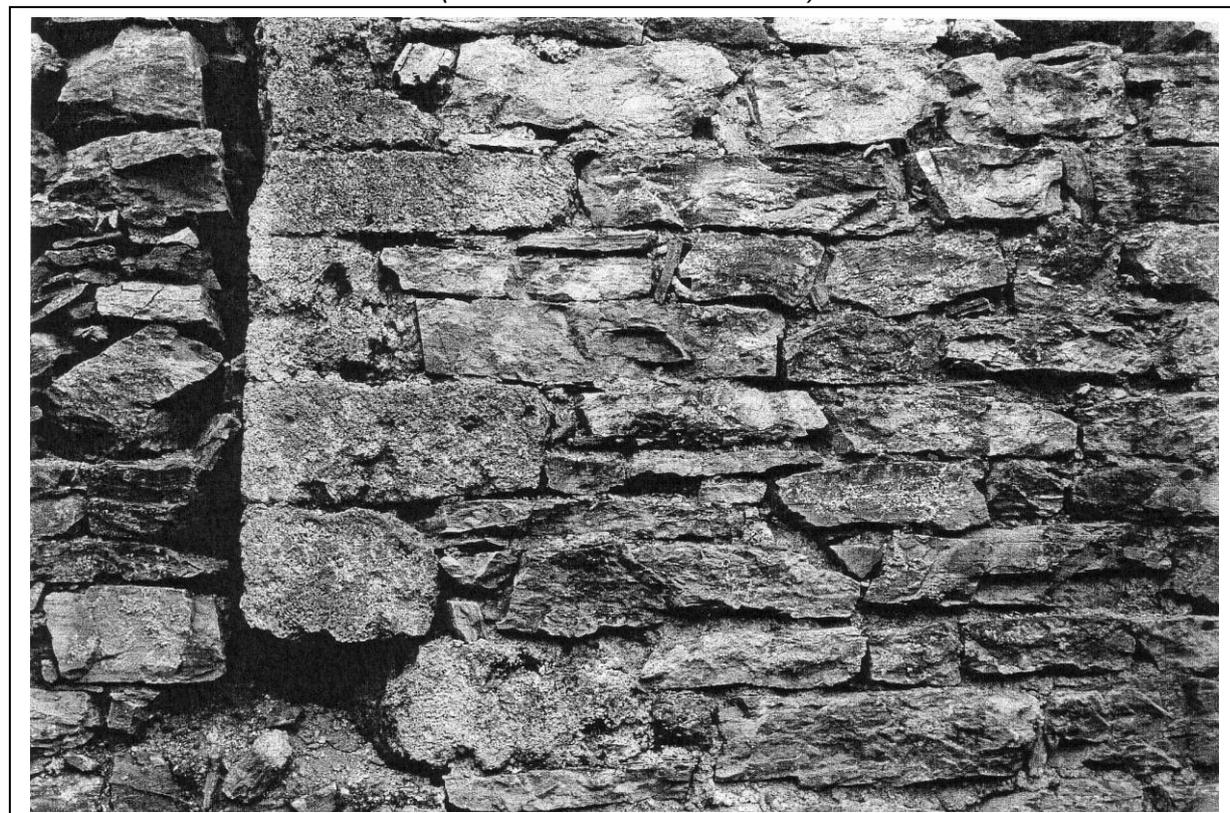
Baunähte in Positionen 3 und 5 (Spätgotische Profilierungen im älteren Mauerwerk)
